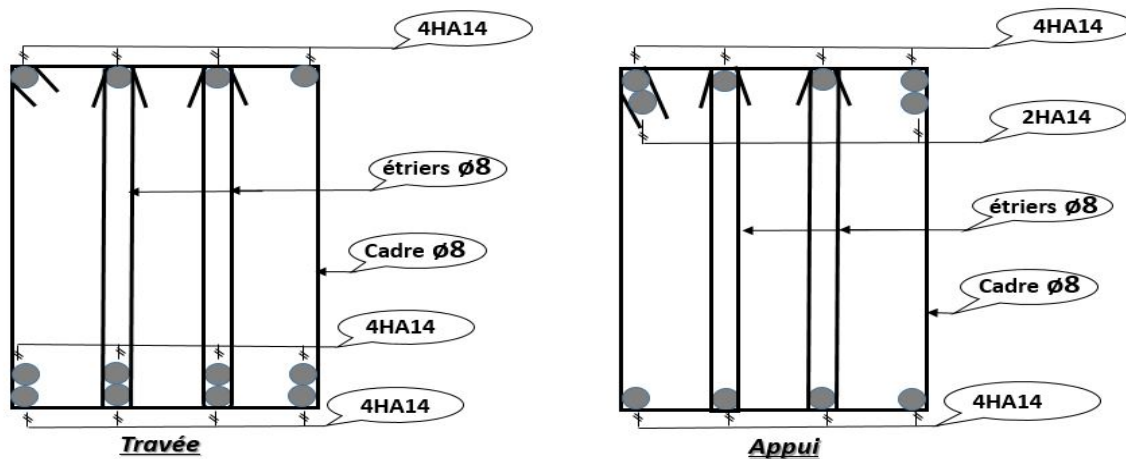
Schéma de ferrailage de la poutre brisée
